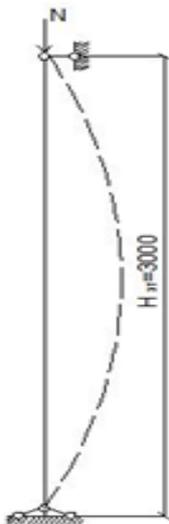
Расчетная схема центрально нагруженного каменного столба третьего этажа.
